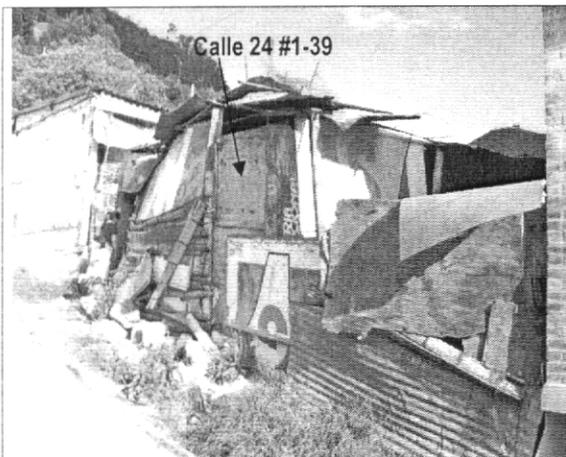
Fachada de la vivienda Calle 24 # 1-39 en material de recuperación, la cual presenta una pérdida de verticalidad debido al colapso de las columnas de madera que la soportan.
